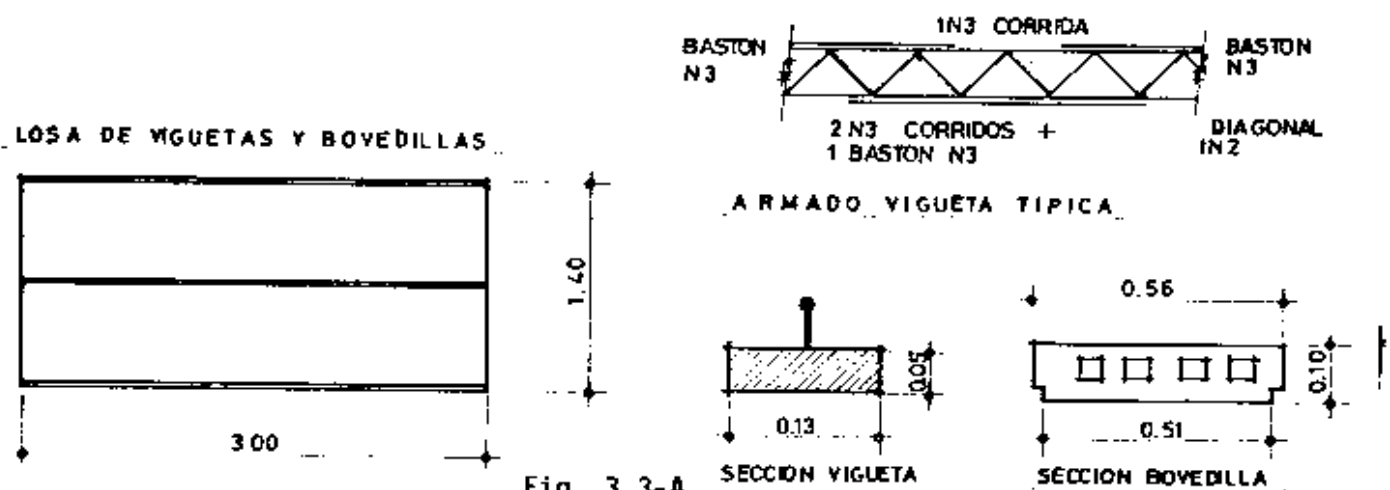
A Detalles losas de prueba, viguetas y bovedillas
